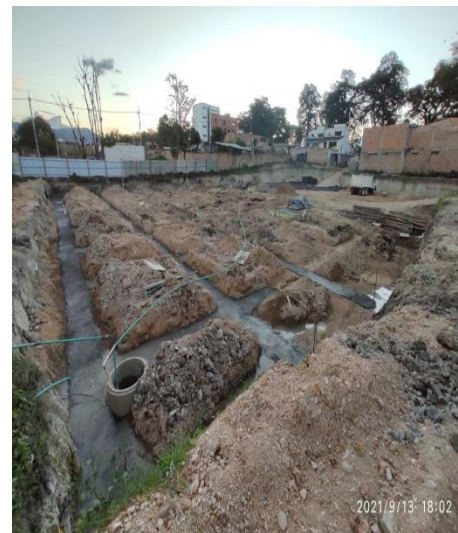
,Capa de solado bajo vigas, fuente: Cifuentes Mafla
